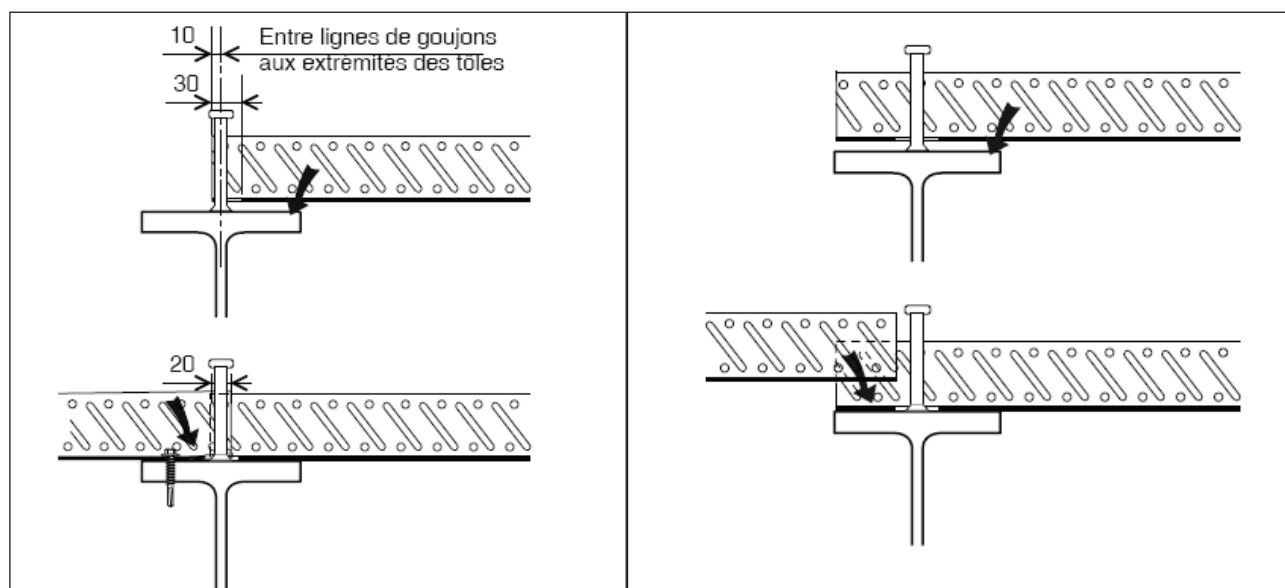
Phasage d’assemblage sur poutre mixte avec connecteurs soudés
